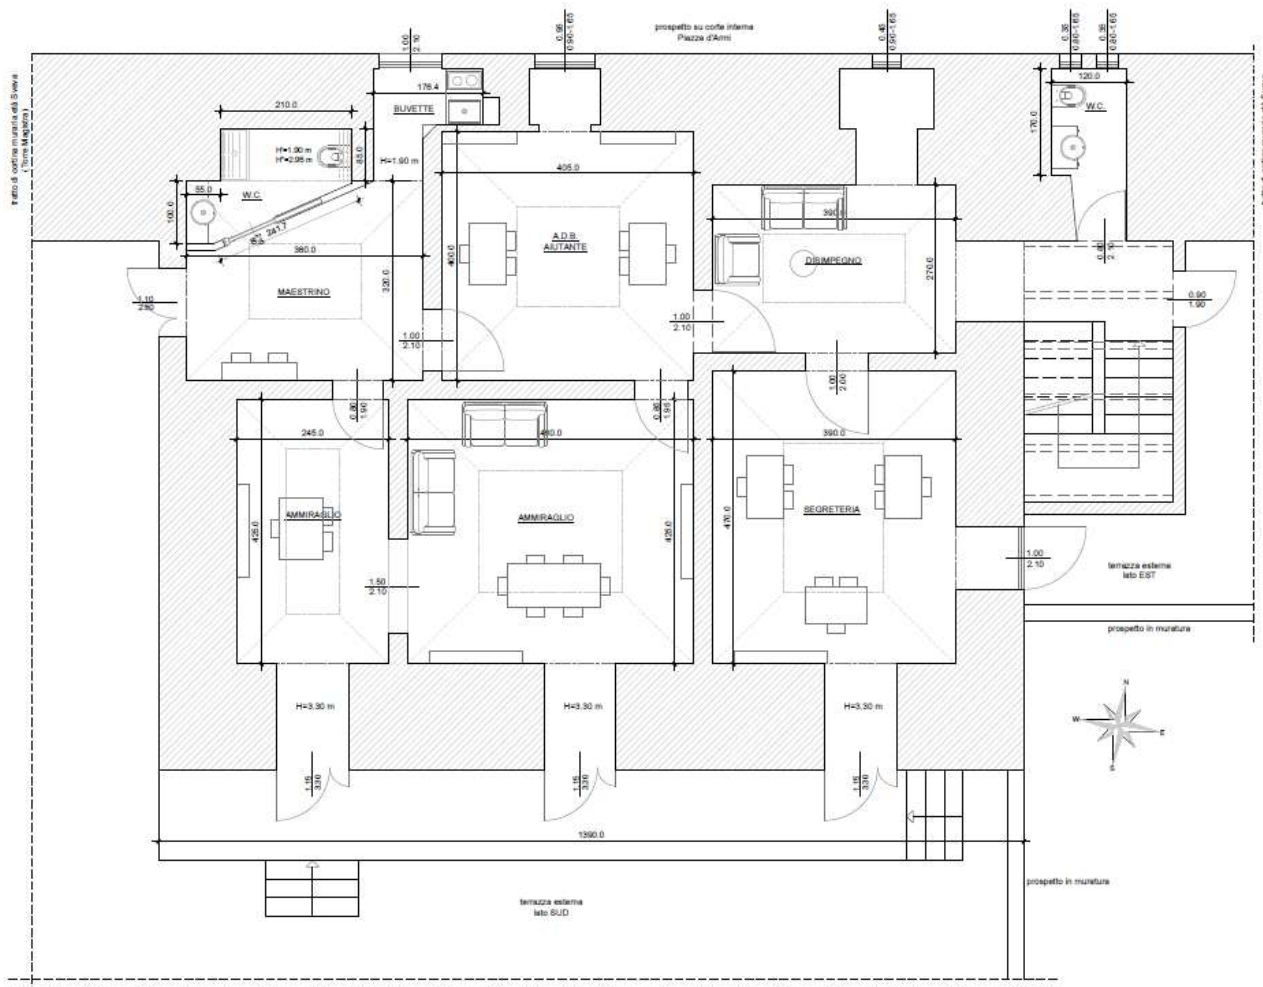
Planimetria generale dello stato di progetto rappresentante la struttura in esame in scala 1:50
